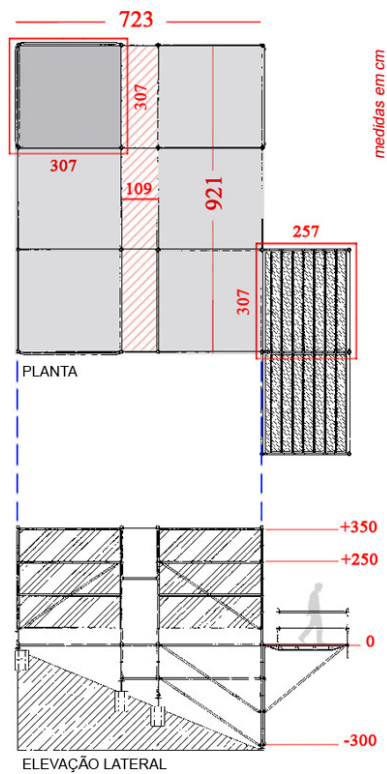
| Planta e elevação lateral da edificação, mostrando os módulos utilizados.
